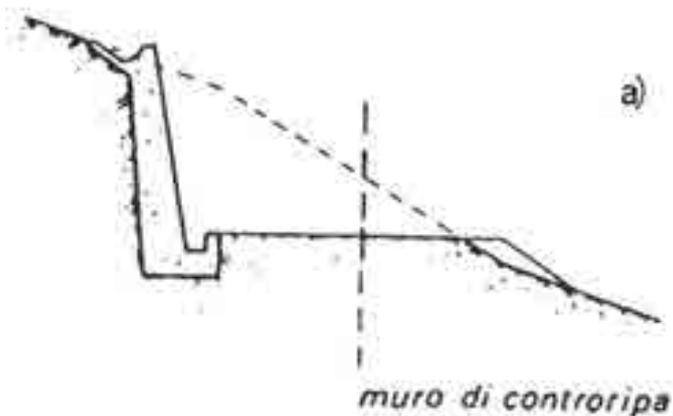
Costruzione di muro di sostegno per sezione stradale in trincea
